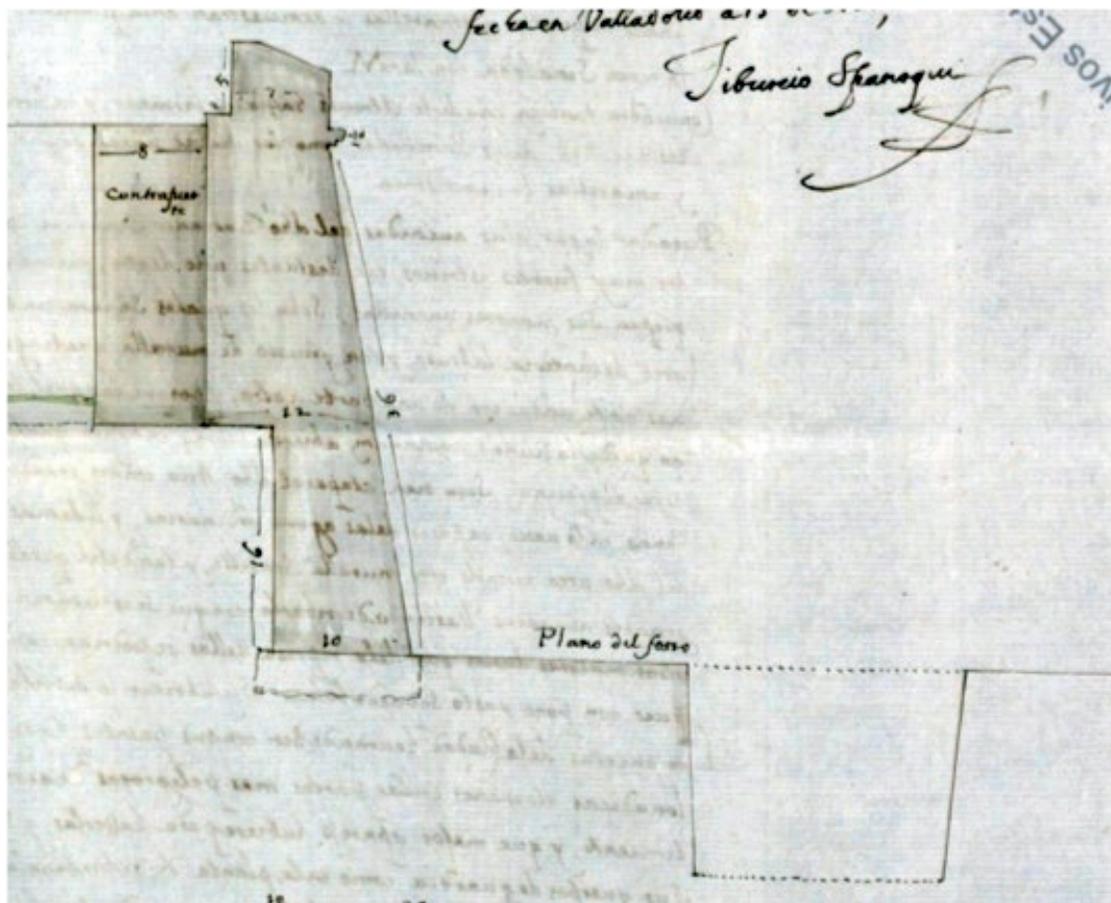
PLANTA DE PARTE DE LA MURALLA DE LA FORTIFICACIÓN DE MALLORCA ; PERFIL DE LA MURALLA Y CONTRAFUERTE Y PLANO [...]. *Detalle*. Spanoqui, Tiburcio, 1602. AGS. Secretaría de Guerra, Legajos, 03352, 24. Con carta del comendador Tiburcio Espanoqui sobre las Fortificaciones de Mallorca, Valladolid 15 de marzo de 1602. Catálogo Colectivo de la red de Bibliotecas de los Archivos Estatales.
